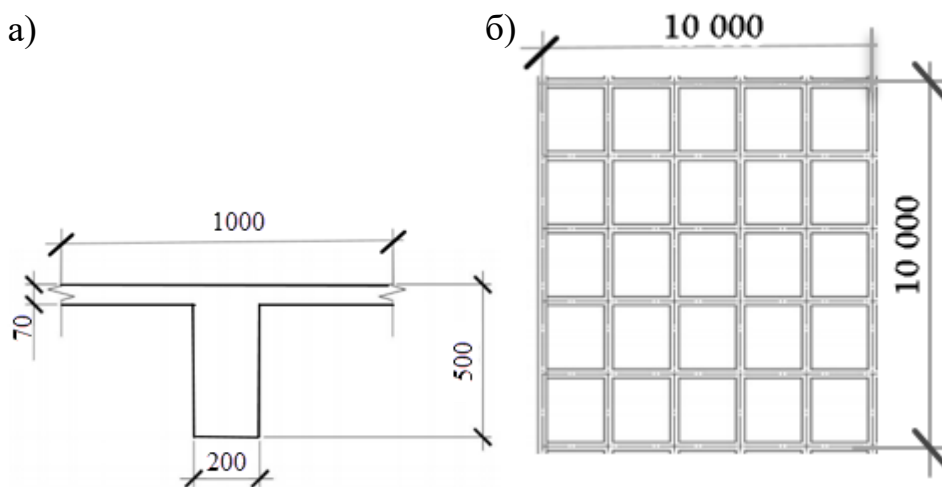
Поперечний переріз залізобетонної кесонної плити перекриття –а;
